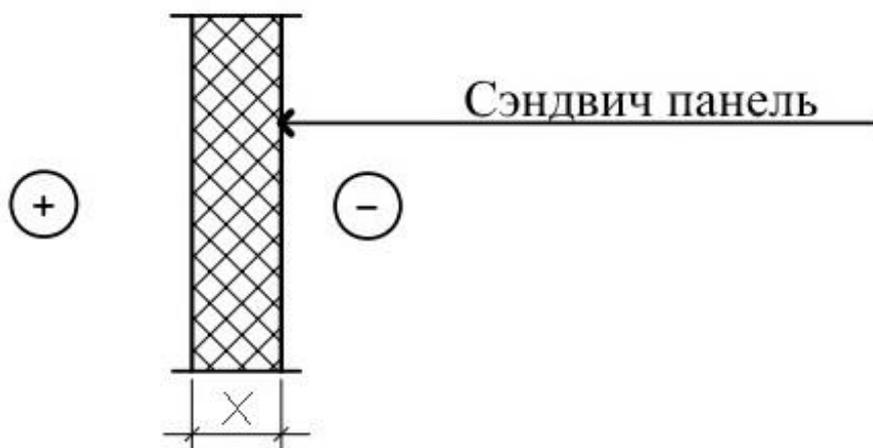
Эскиз наружной ограждающей конструкции стен
